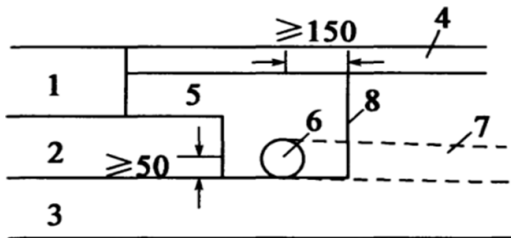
沥青路面边缘排水示意图(尺寸单位: mm)
